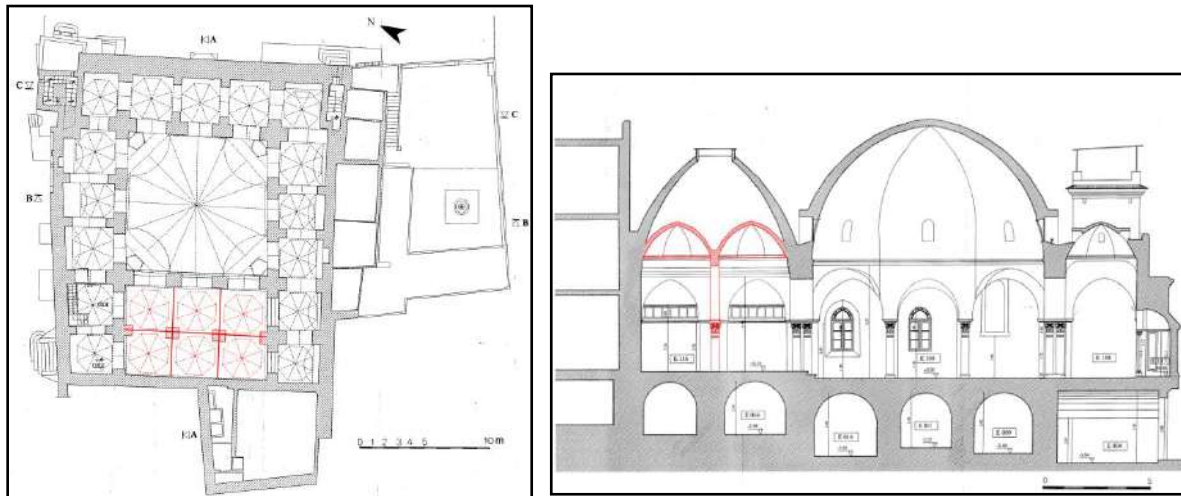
Plan et coupe longitudinale sur la mosquée 'Alī Bidjnīn.
